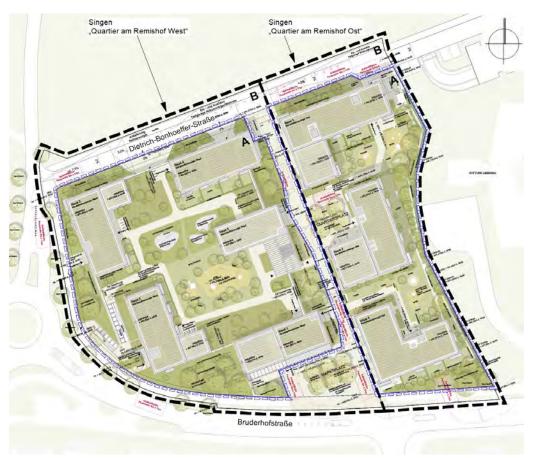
Lageplan Städtebaulicher Entwurf Gesamtprojekt - MBPK Architekten + AG Freiraum, 30.09.2025
